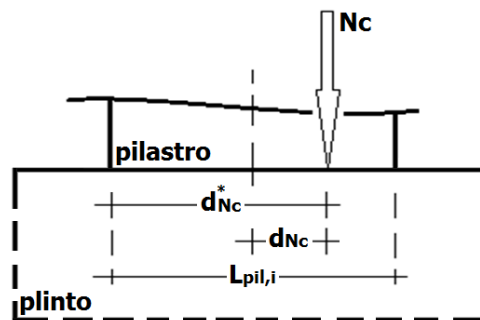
posizione della risultante degli sforzi di compressione ( $N_c$ ) alla base del pilastro, nella direzione i-esima
